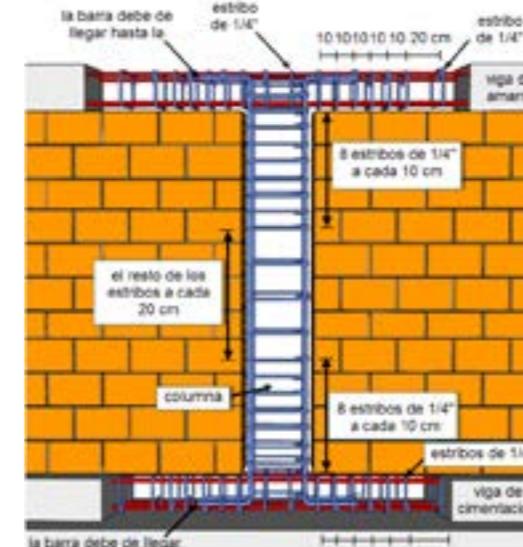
Armados y dimensiones de columnas y vigas de confinamiento
